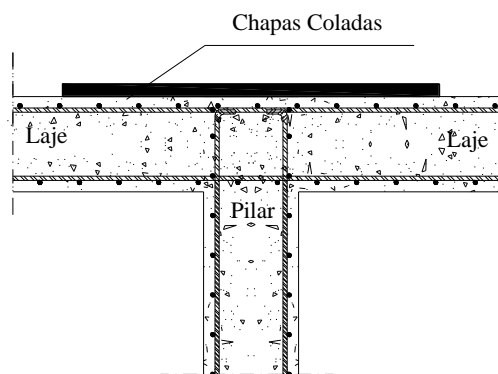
Reforço externo por armadura de flexão-tracção [40]
